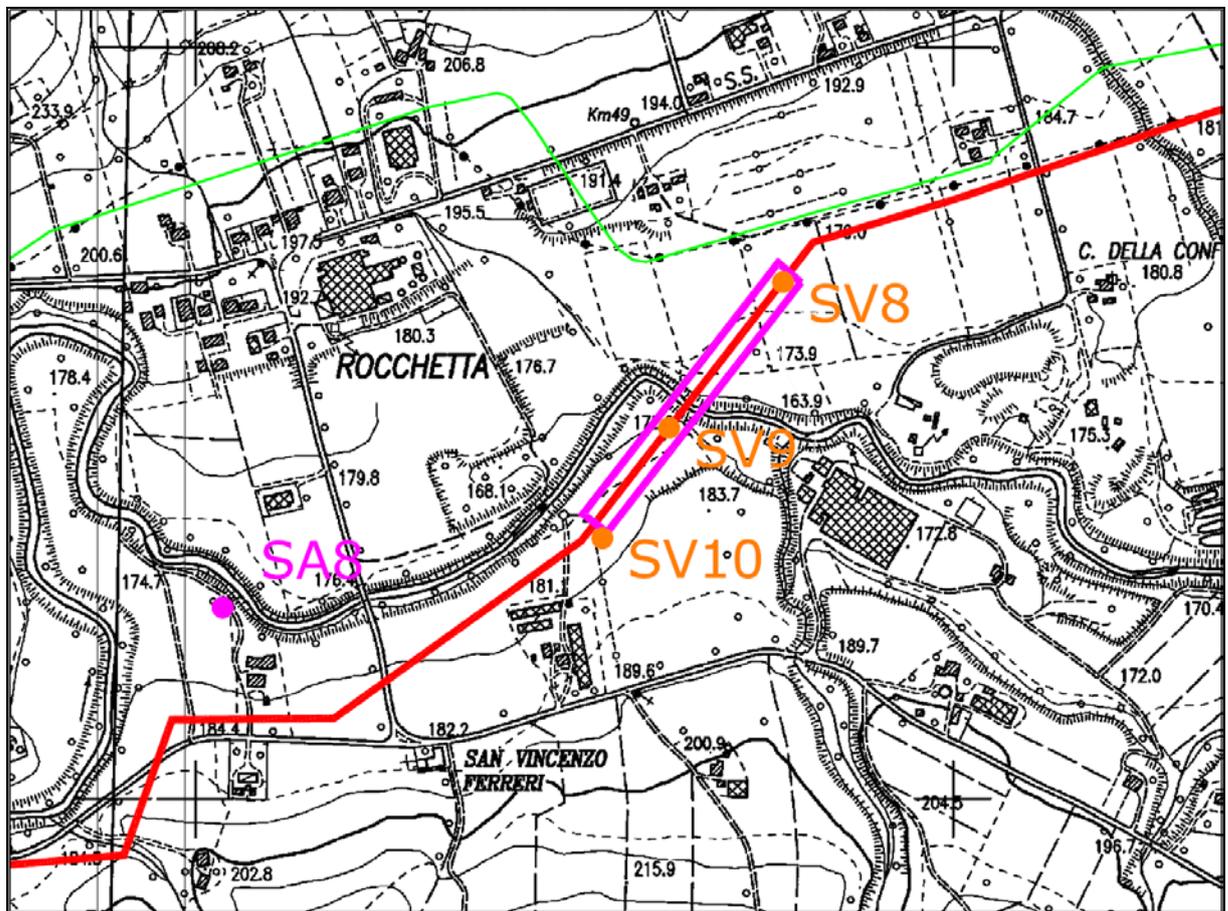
/A: Planimetria area 1° Attraversamento in scala 1:10000, con ubicazione sondaggi
